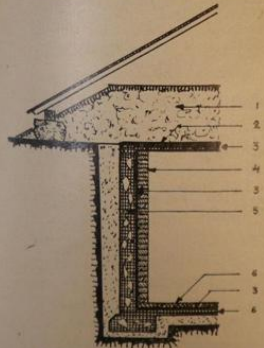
Louhokiviseinä, osa laipio- ja lattiarakennetta, 1 täyte, 2 laipion eristys, 3 betonilaipio, 4 betoni- tai tiiliverho, 5 louhokiviseinä, 6 betonilattia.
